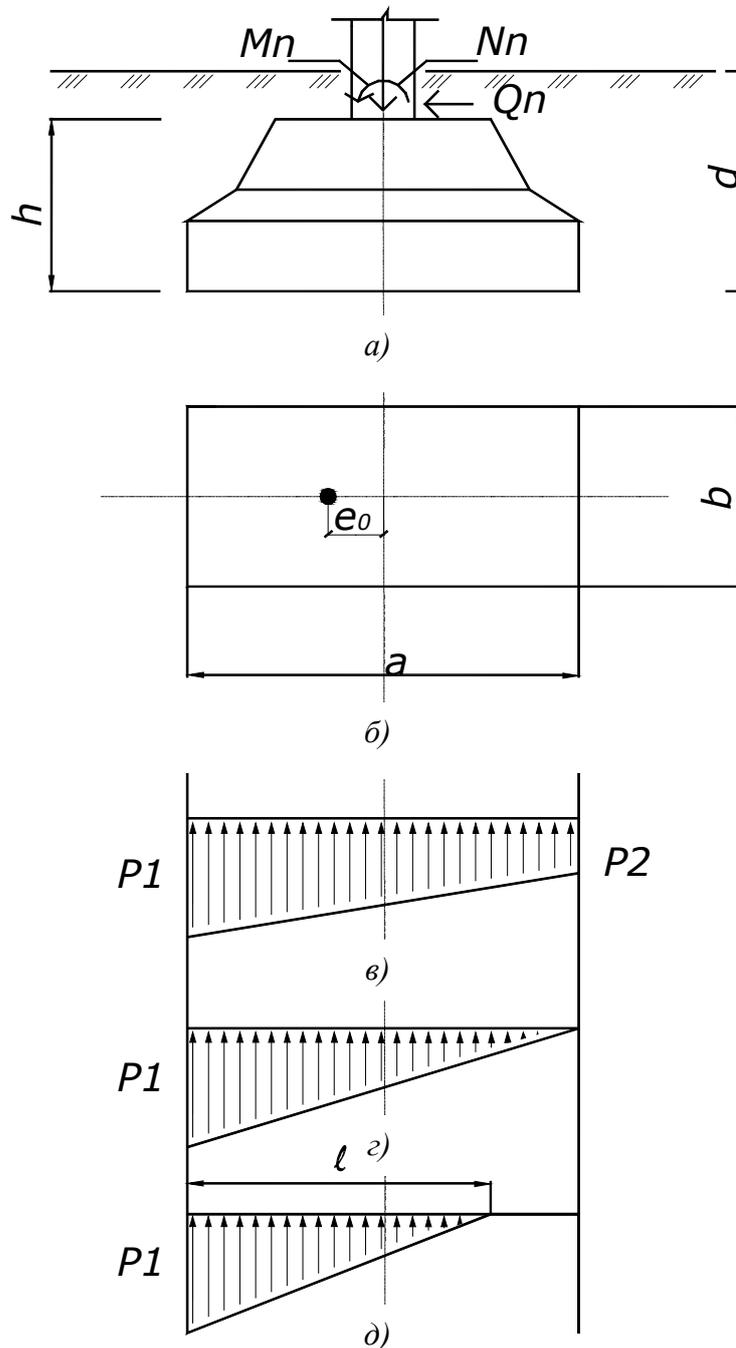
Усилия на фундамент и давление под подошвой:
